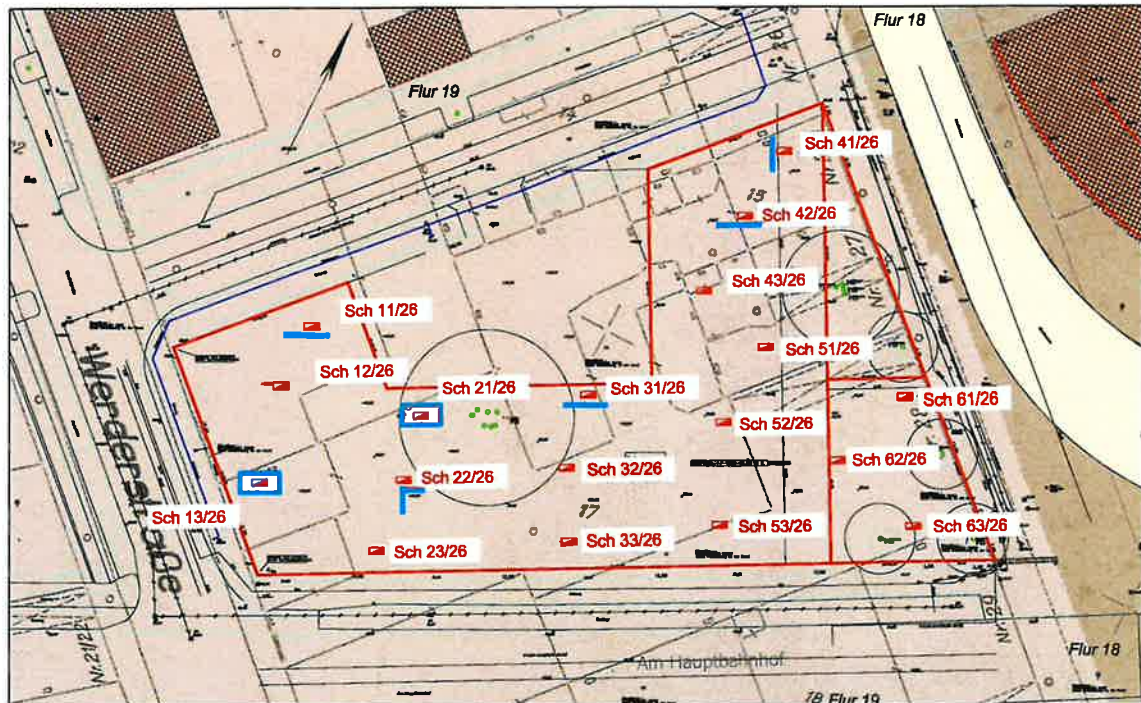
Lageplanausschnitt: blau – Mauerwerkswände in den Schürfen (Hintergrund: hist. Bebauung)
